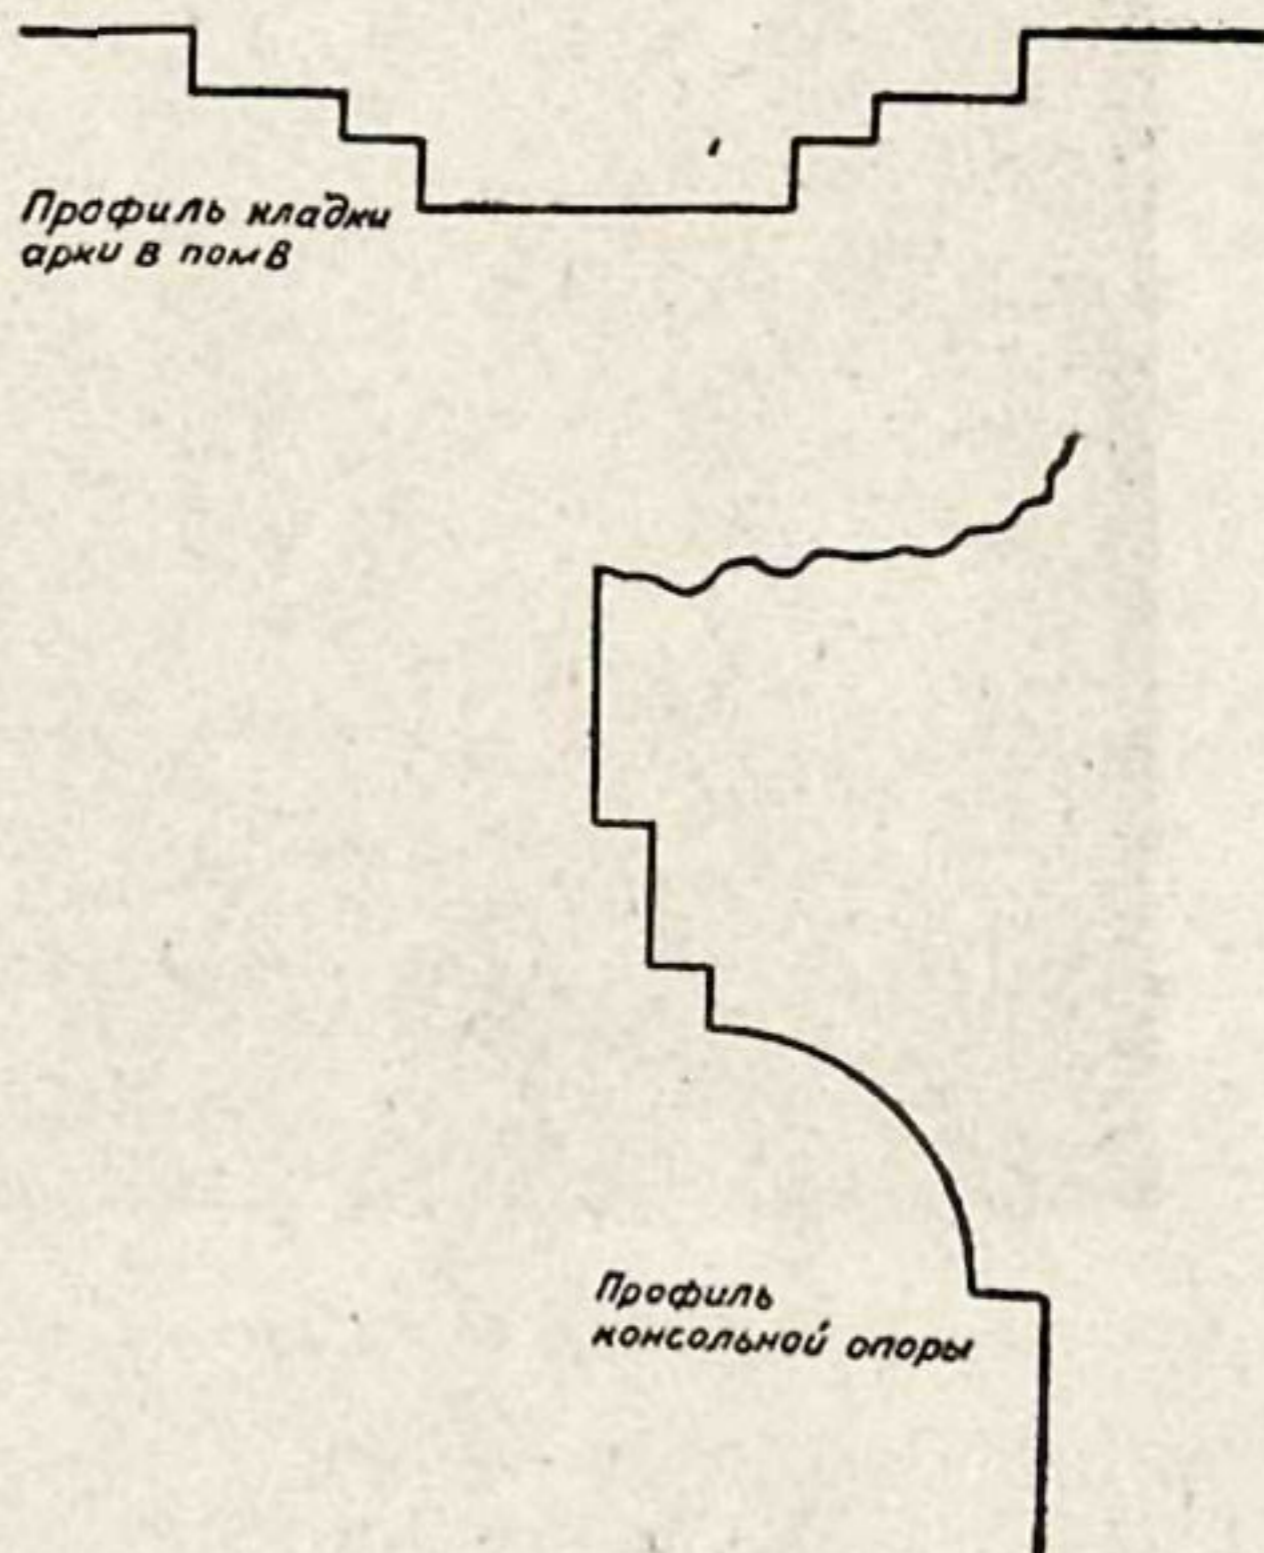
Профиль консольной опоры и внешней стороны кладки арки в помещении В здания № 13.
